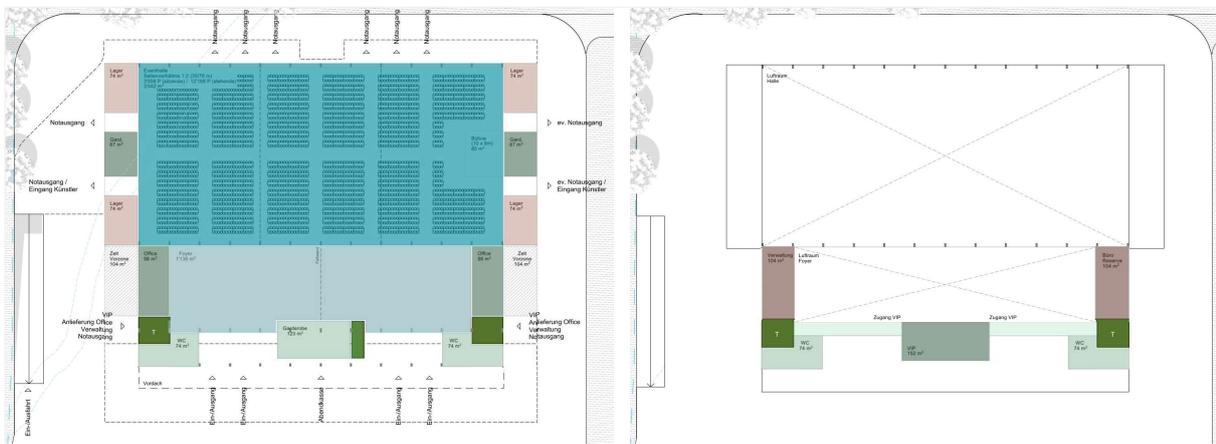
Grundrisse Erdgeschoss und Obergeschoss [Ritter Schumacher AG Architekten ETH HTL AA SIA, 26.02.2020]
